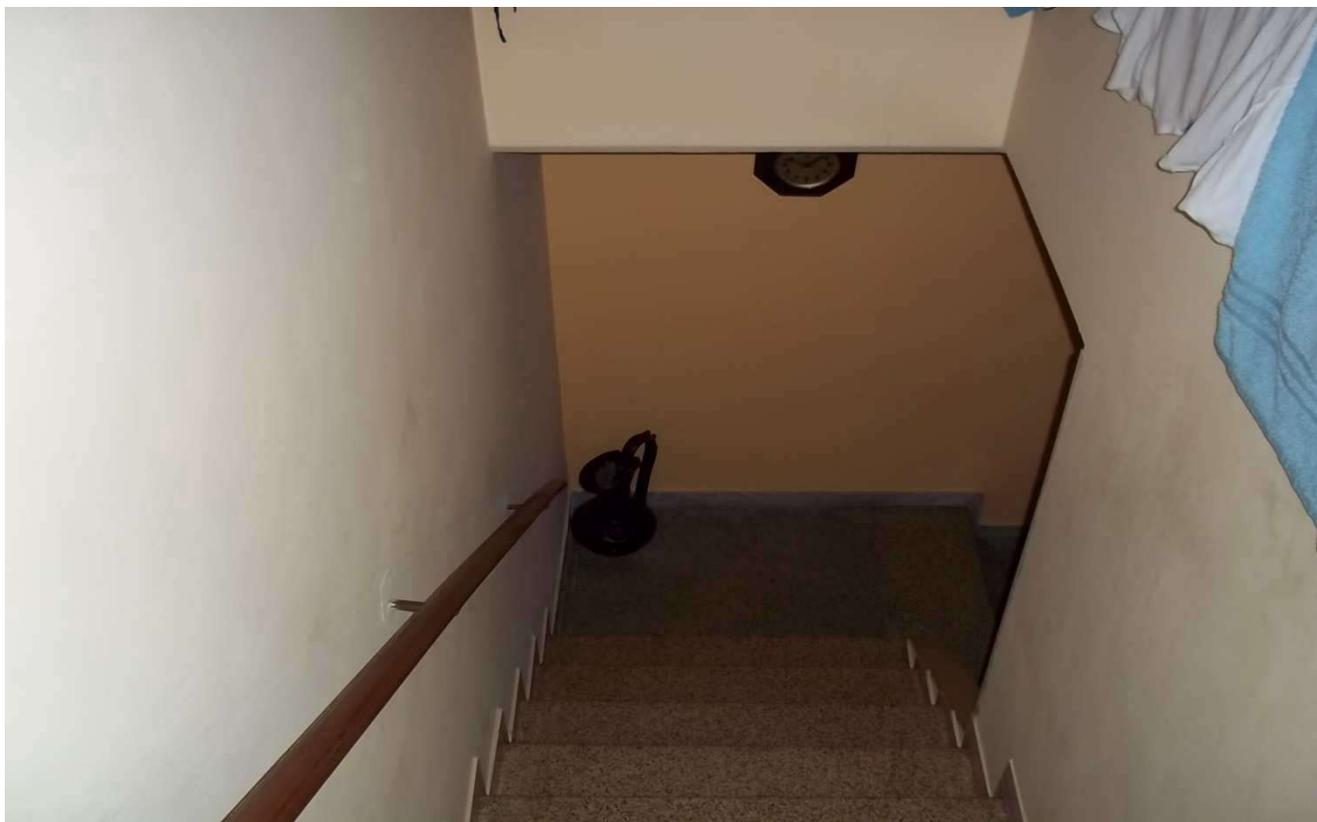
particolare vano scala interno fabbricato - lotto 2 –
